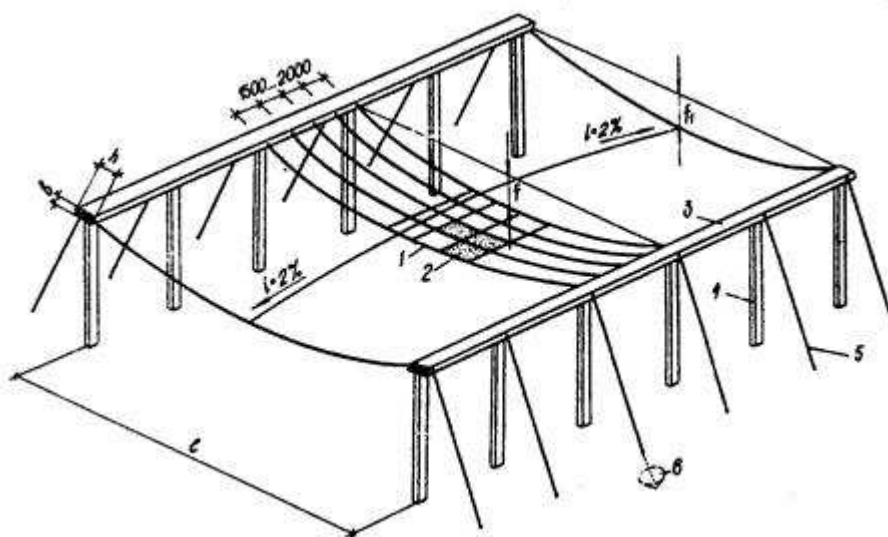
Схема вантовых покрытий с прямоугольным планом здания:
